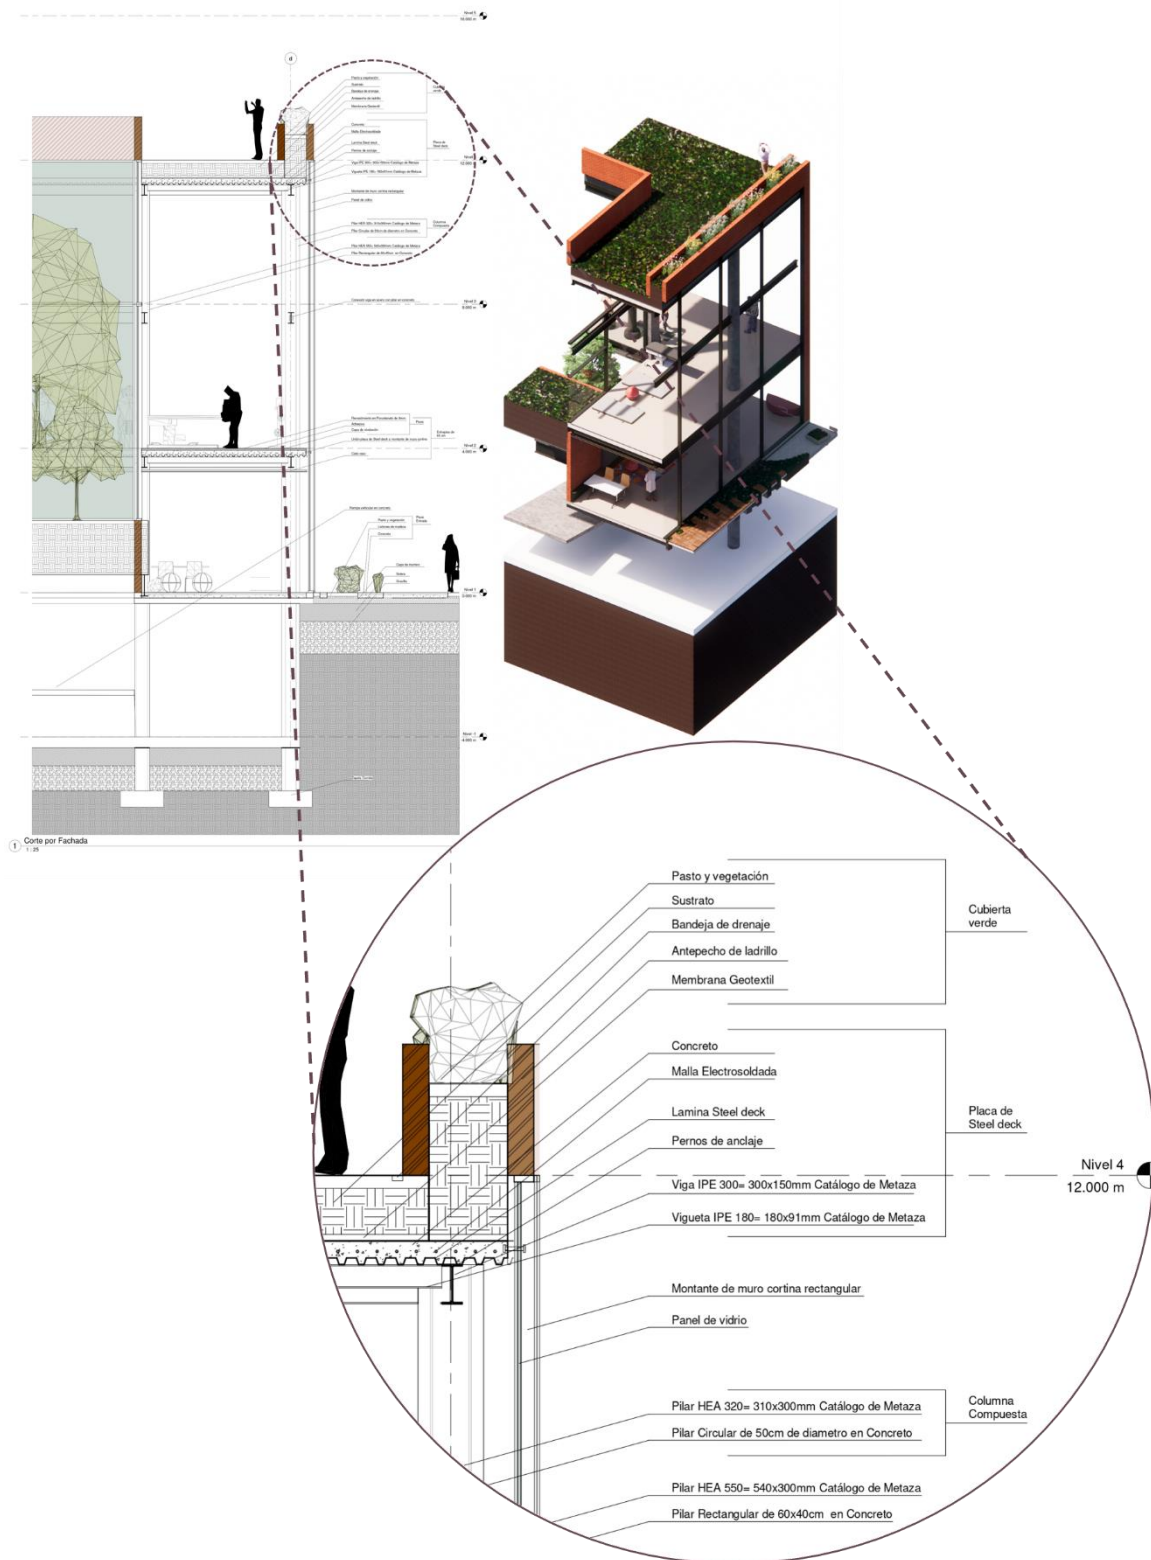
Corte por fachada. Fuente: Elaboración propia.
